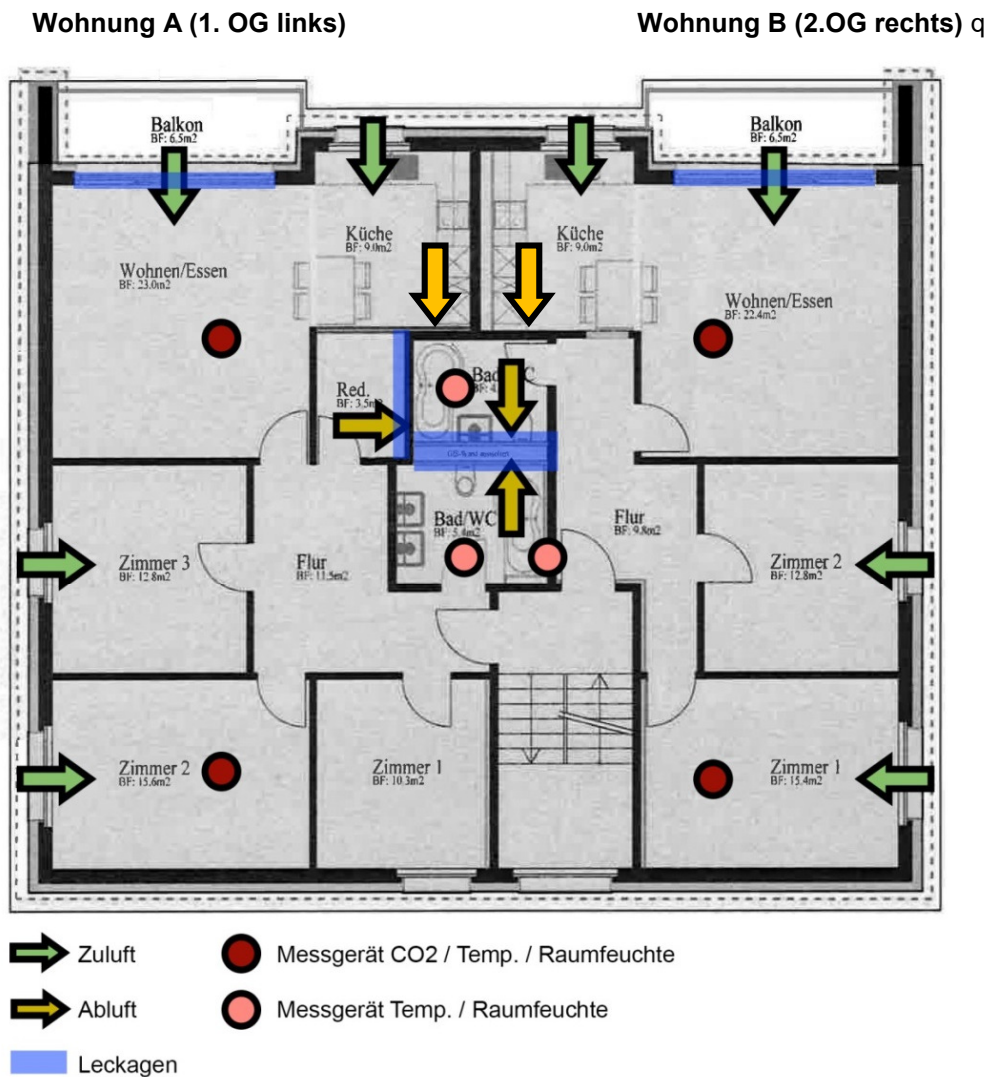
MFH Linthal: Grundrisse Wohnungen A und B
